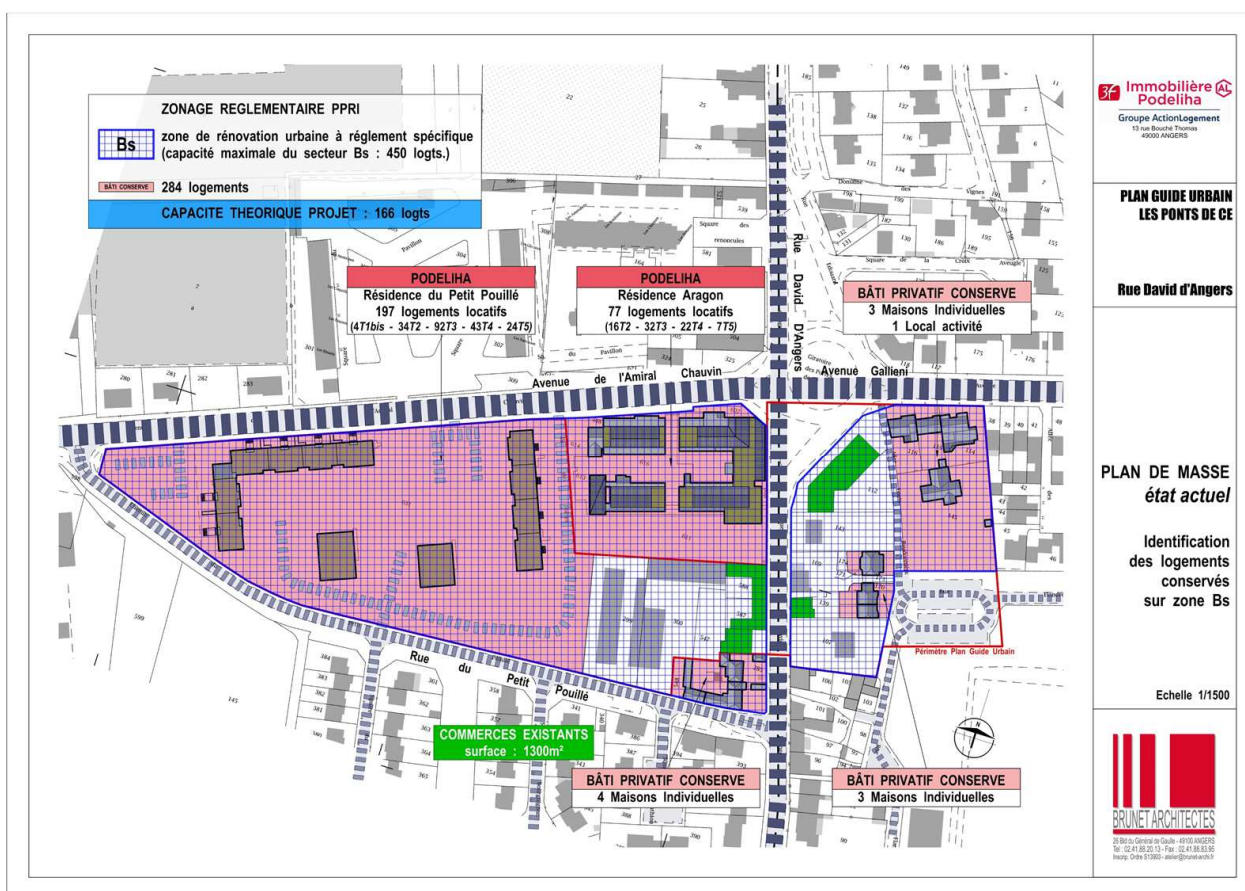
plan de masse actuel (Brunet Architectes, 2020).
